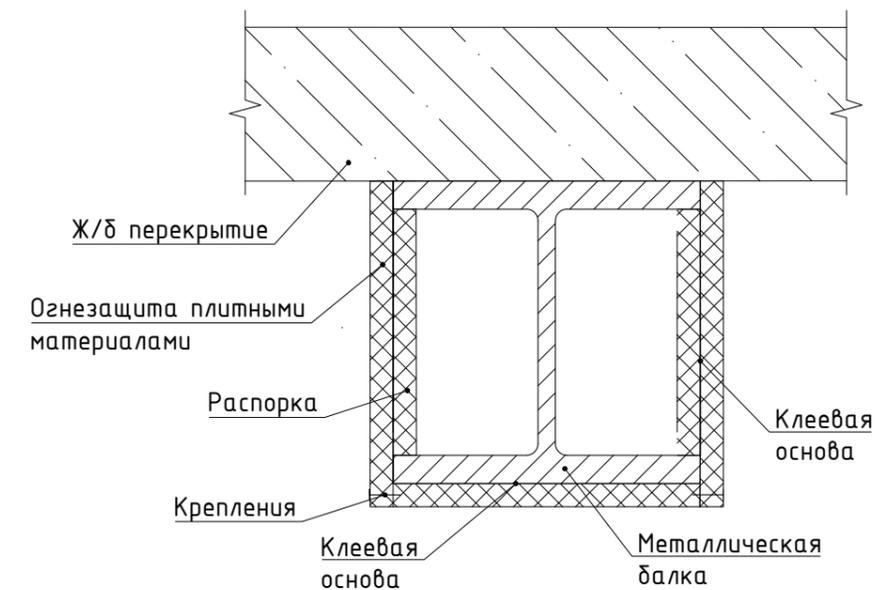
Огнезащита плитными материалами металлической балки, примыкающей к ж/б перекрытию
